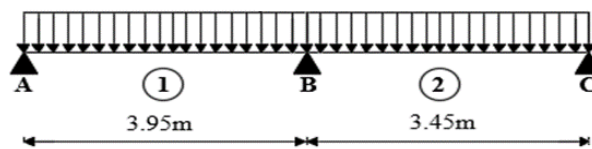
Schéma du 2^{ème} type de poutrelles
